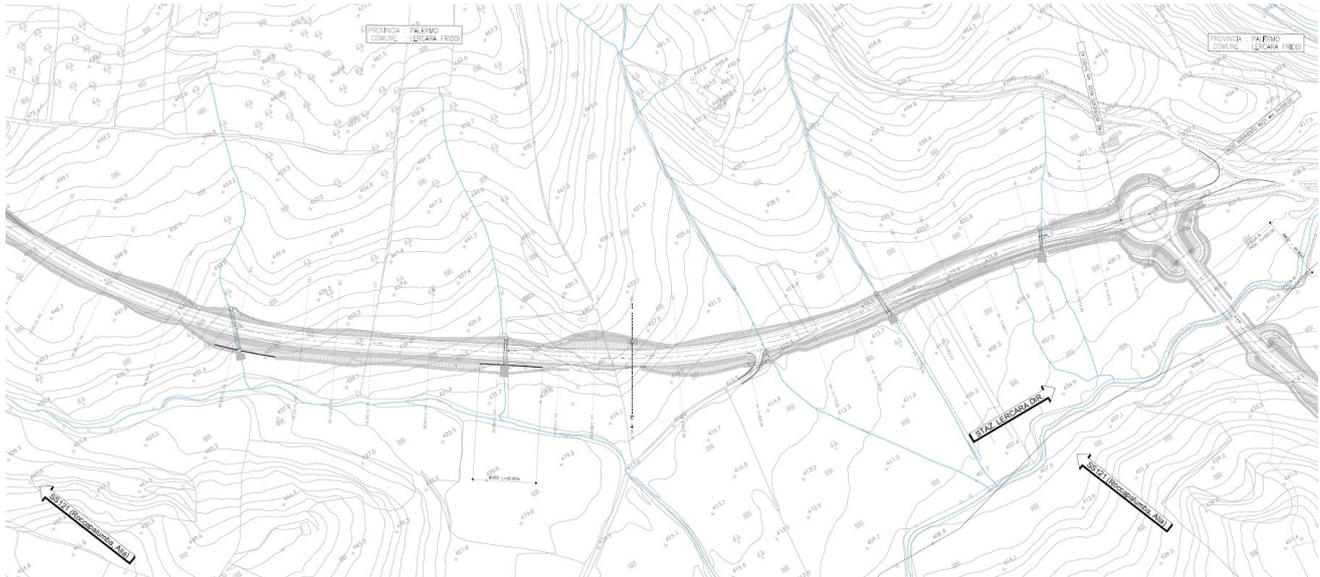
Planimetria di progetto dalla Km 2+462 alla Km 3+170
